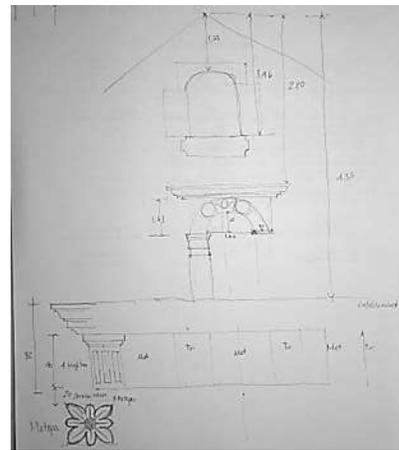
Detalle de fachada, capilla San Juan Bautista. Fuente: elaboro Arq. Ma Elena Cortes
